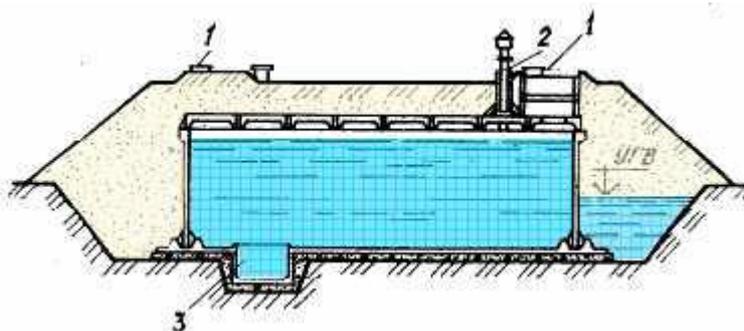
Железобетонный заглубленный водоём-резервуар: 1 – люк-лаз; 2 – вентиляционная труба; 3 – приямок; УГВ – уровень грунтовых вод
